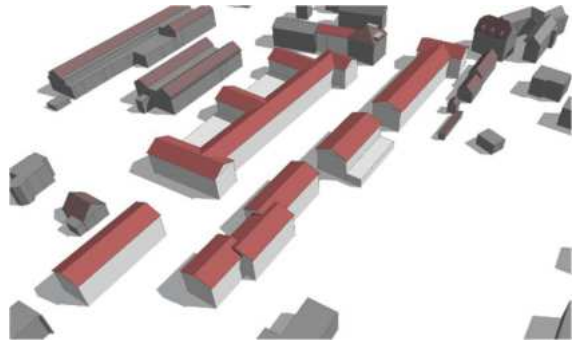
Baumassenstudie Ansicht Nord-West Neu
